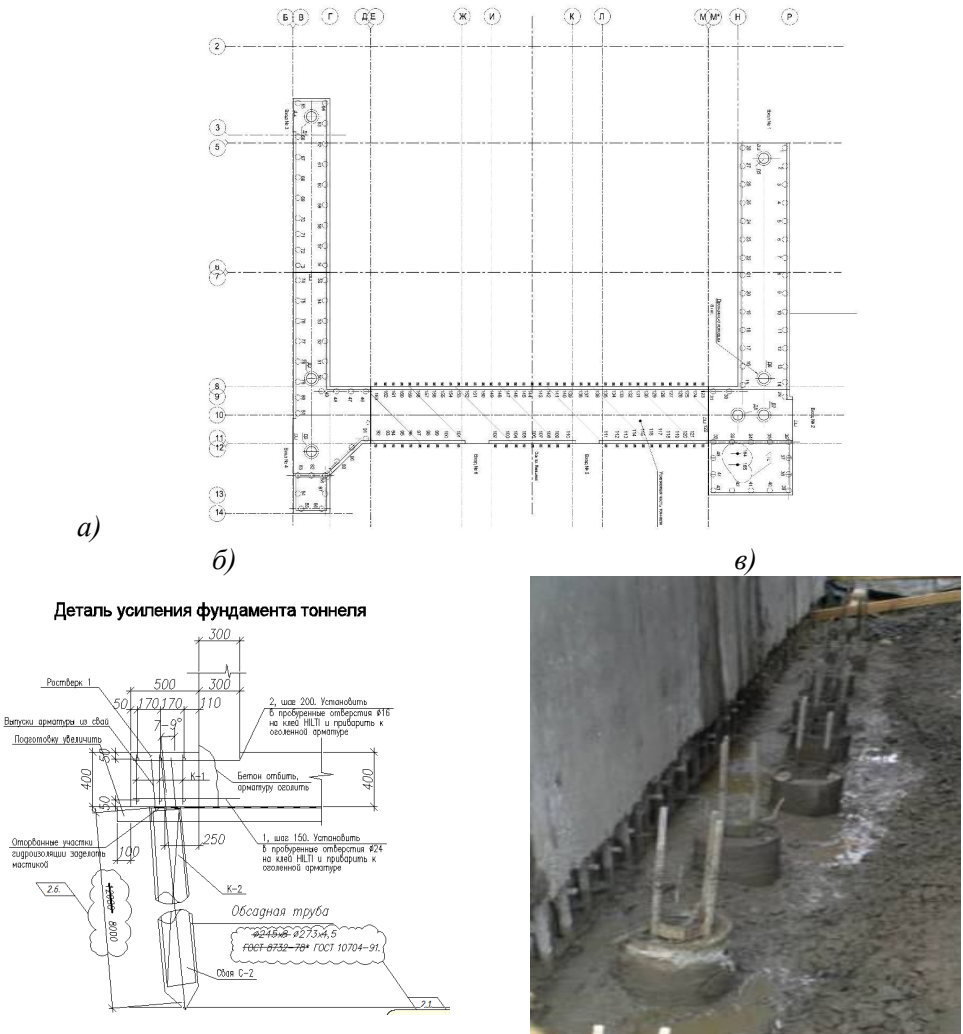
Подведение трубобетонных свай усиления под существующий плитный фундамент: а- общий план подземного пешеходного перехода с расположением свай усиления; б-свая; в-оголовки погруженных свай из трубобетона с анкерными выпусками
